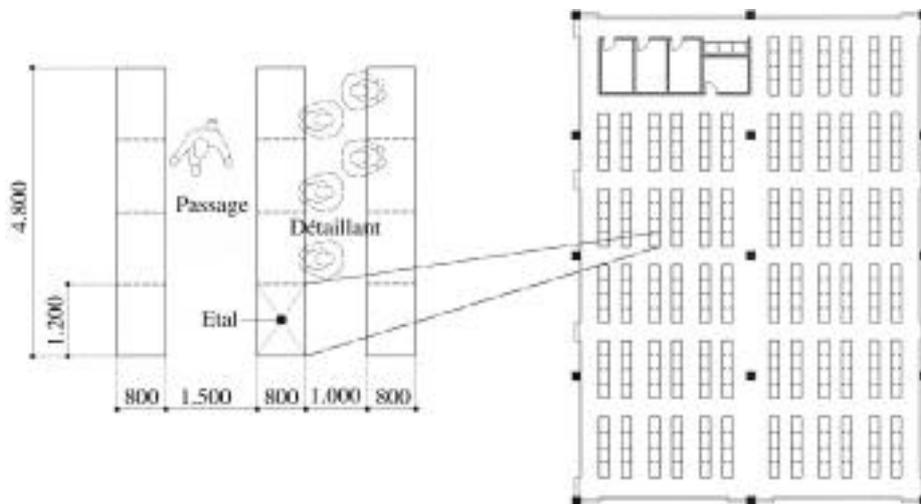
Spécifications et disposition générale dans la zone de vente au détail (unité : mm)
